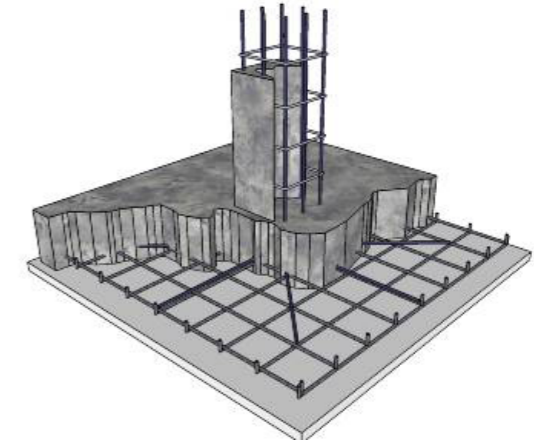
Ejemplo hormigonado de zapatas aisladas
